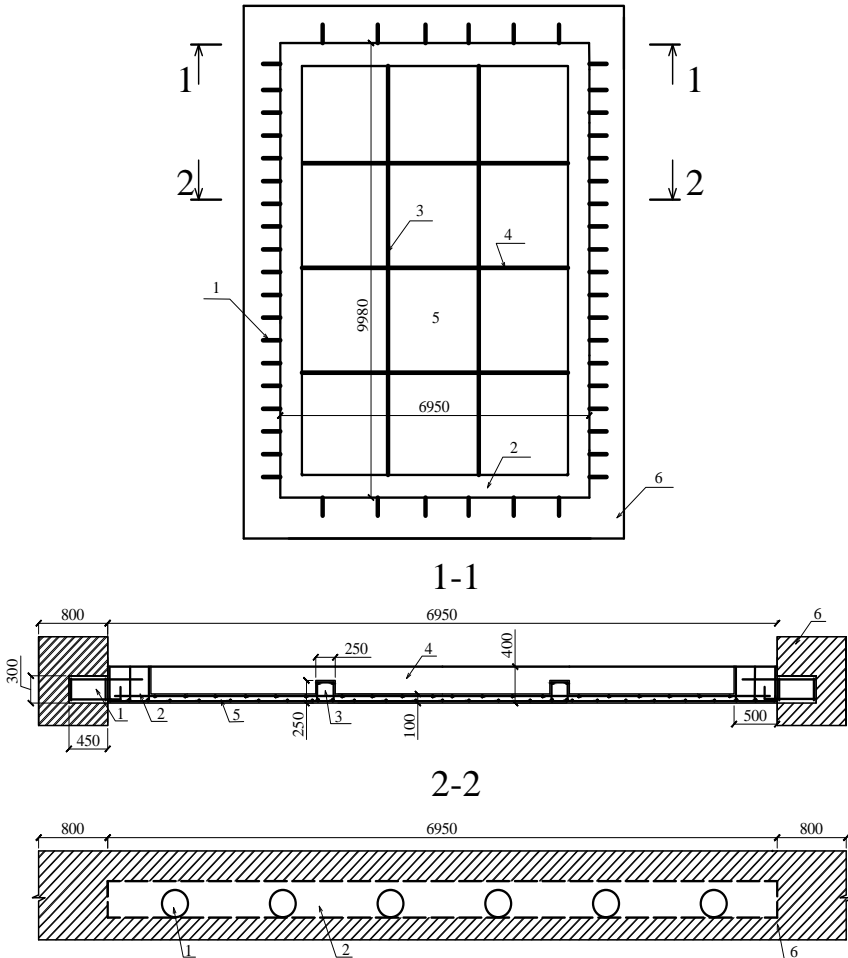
Схема виконання різновиду реконструкції фундаментної системи шляхом підведення суцільної монолітної залізобетонної плити:
